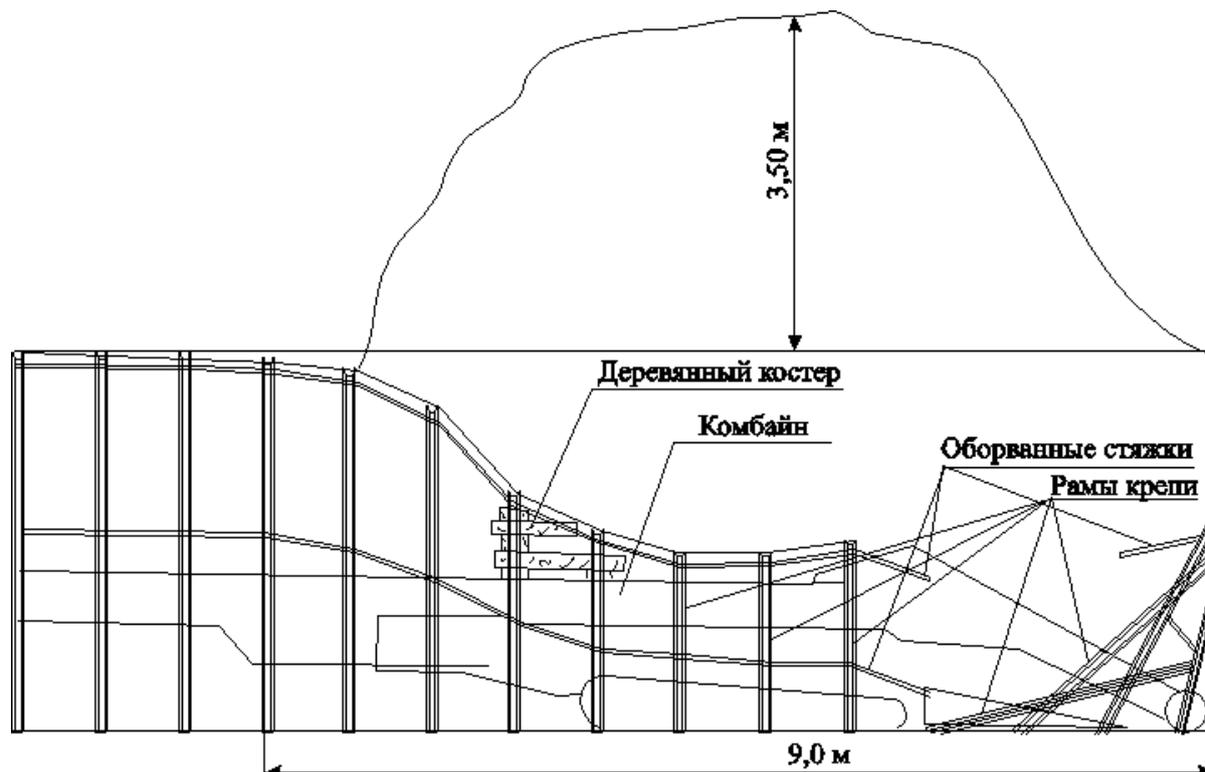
Эскиз места обрушения пород кровли в забое 7-го северного вентиляционного штрека
